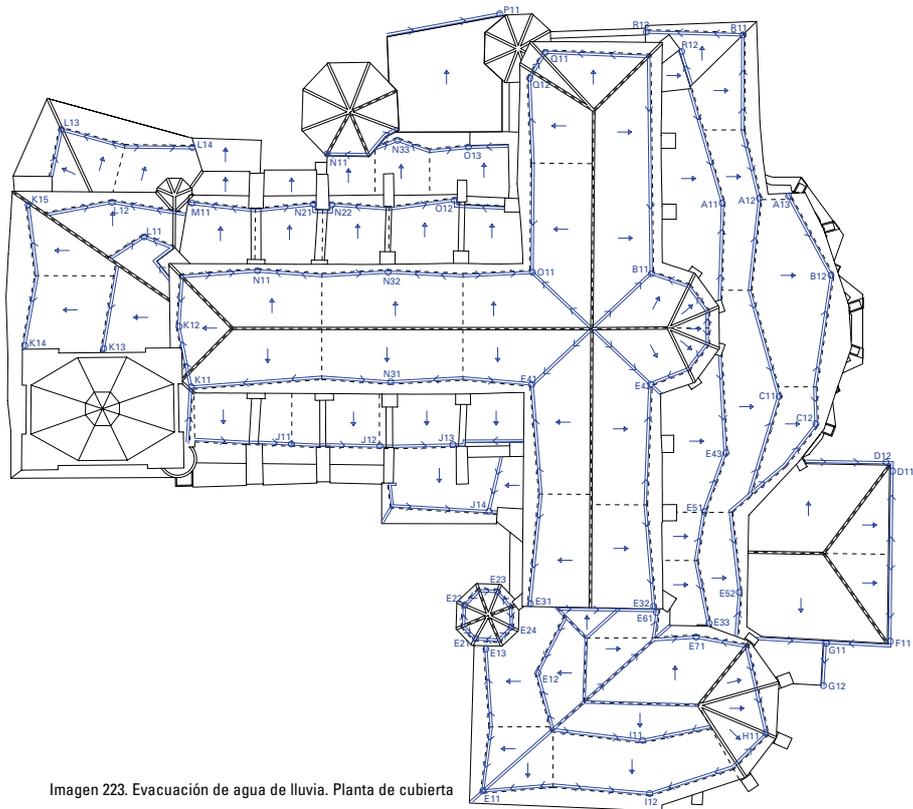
Evacuación de agua de lluvia. Planta de cubierta
